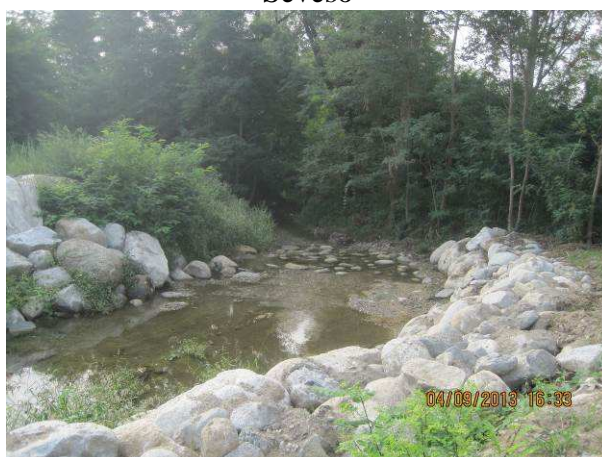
FIV-SE-03 - alveo modificato vista in direzione del punto di prelievo
